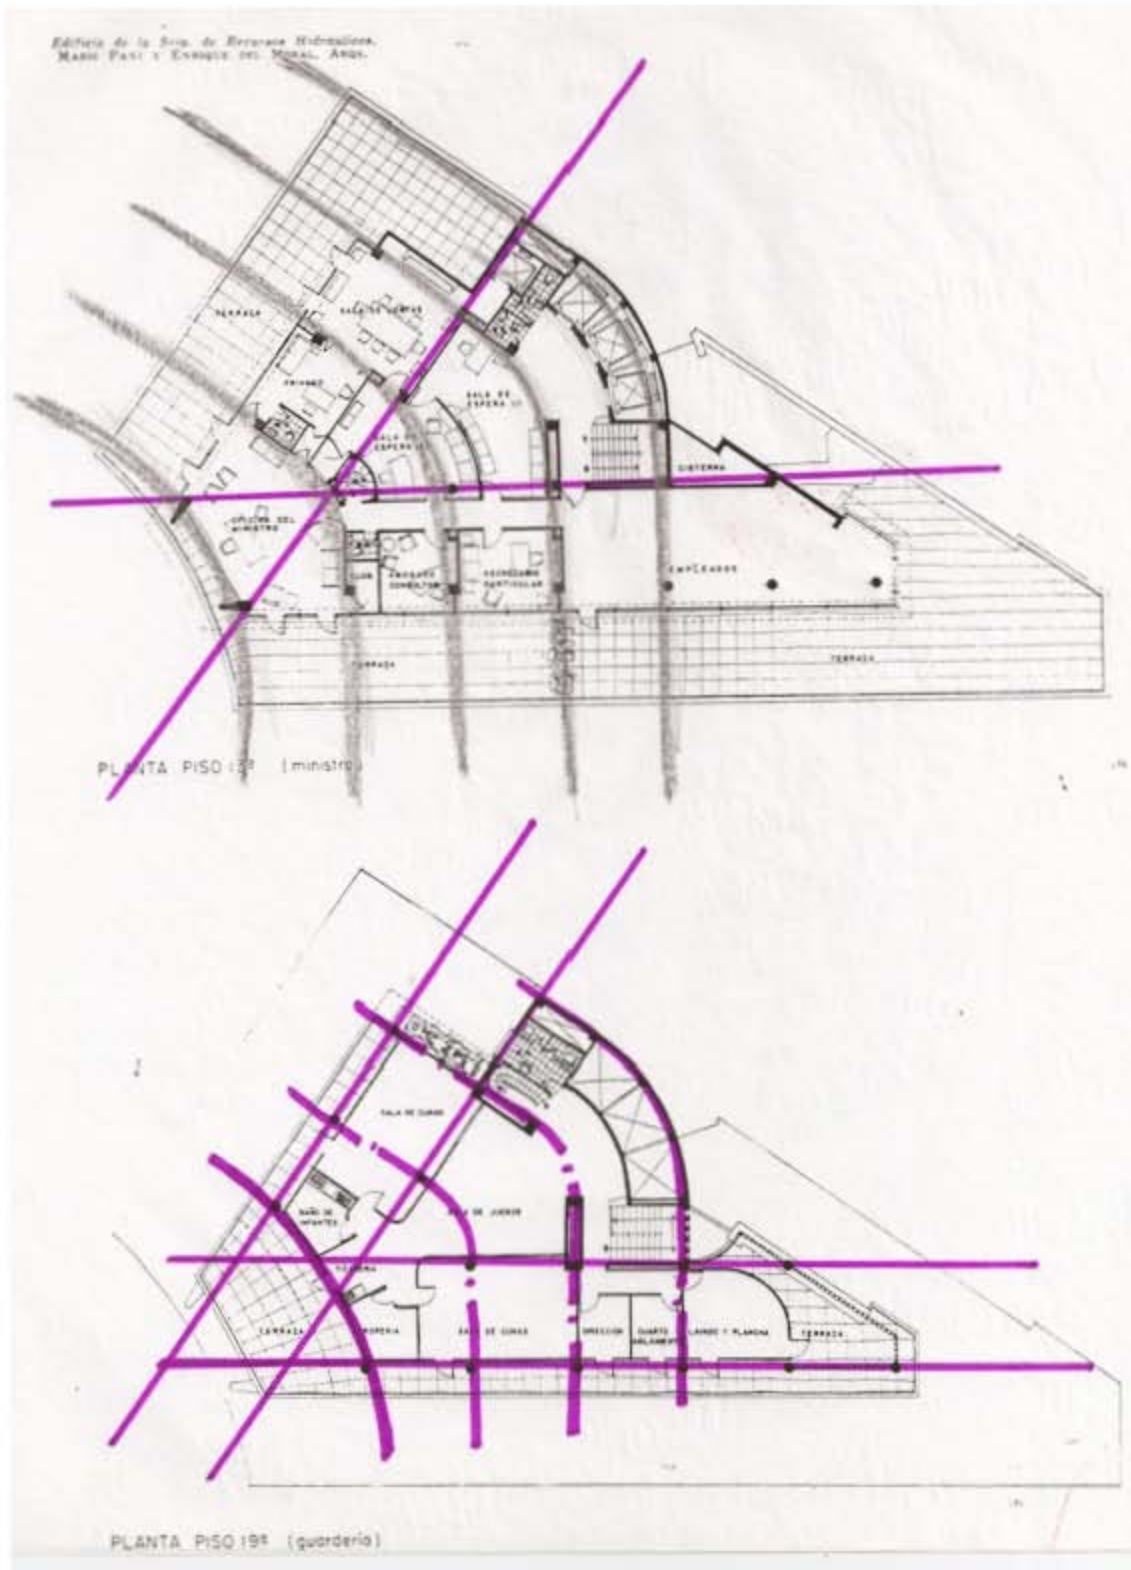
Alternativa B. Ejes compositivos radiales en plantas arquitectónicas
